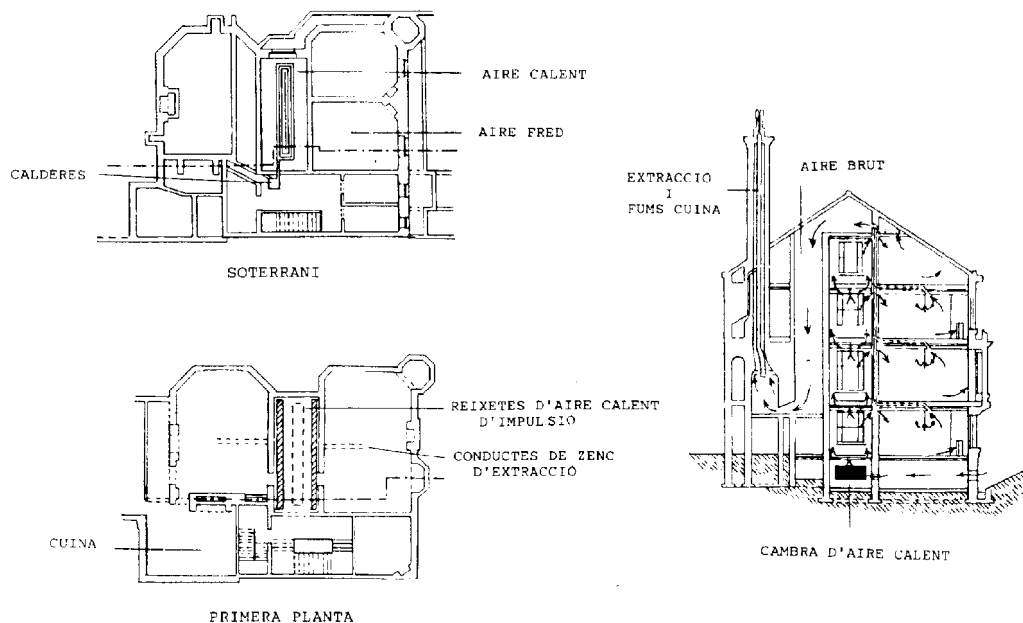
Plantas y sección del "Octogon house" (Dr. John Hayward)
